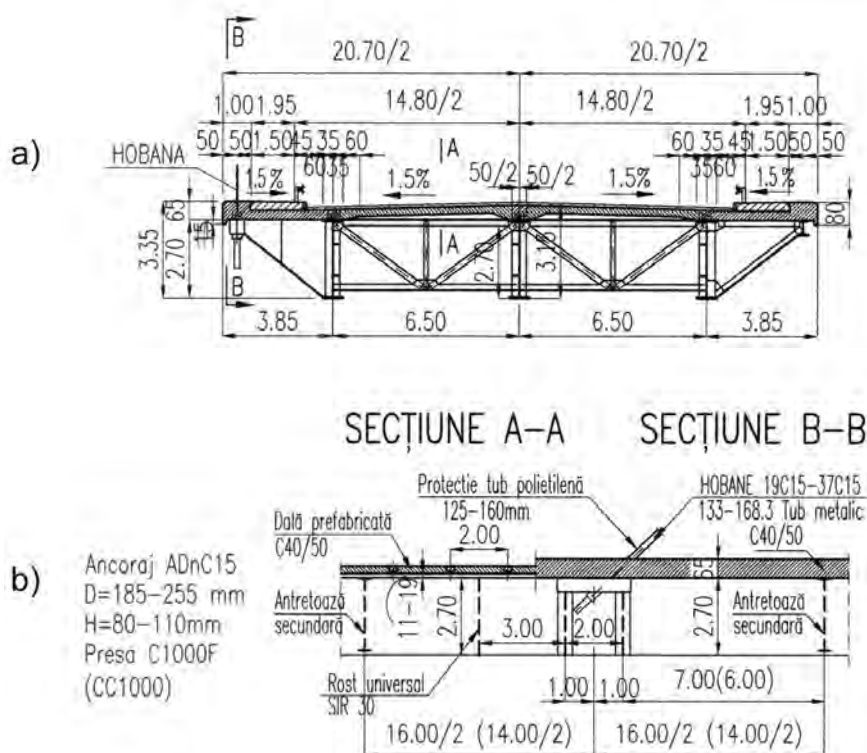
Pod hobanat. Platelaj metalic cu placă din beton armat
